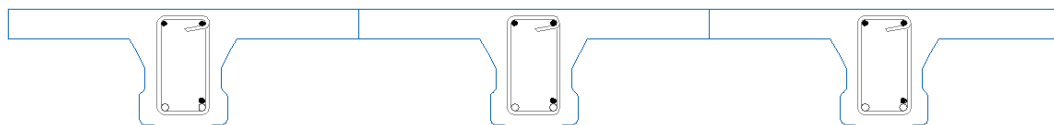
Sección transversal de nervaduras con acero de refuerzo longitudinal y transversal.
